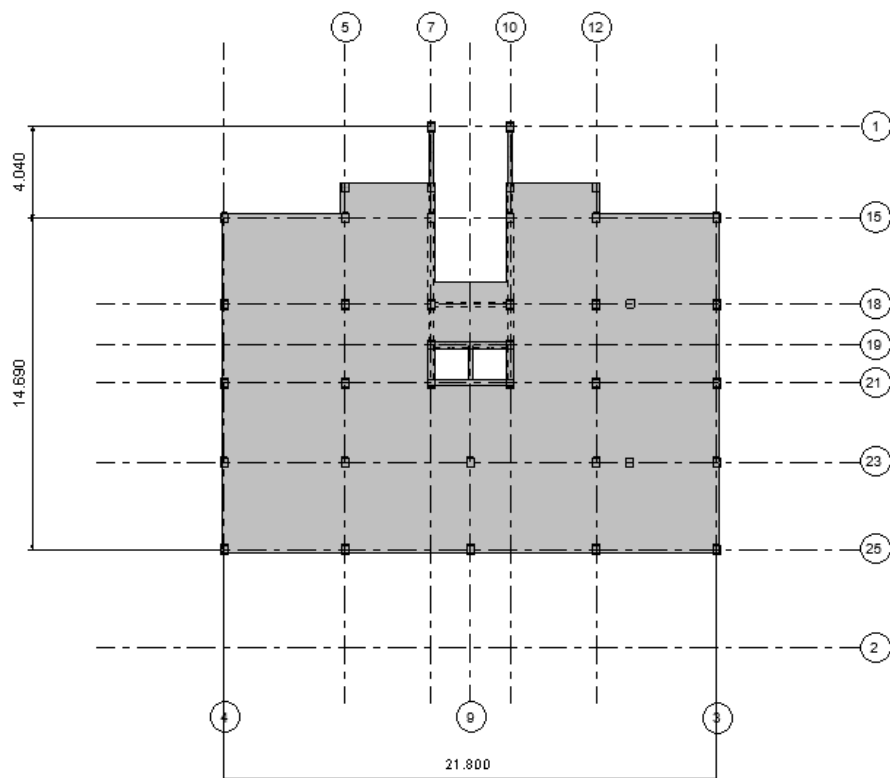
Planta estrutural do sótão da solução estrutural 1 (Revit).
